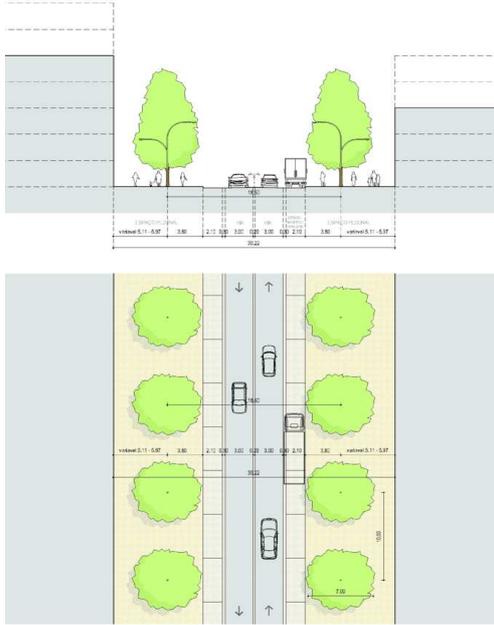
Modelo 1 (perfil tipo) | Projecto de Intervenção para a Avenida Dr. Lourenço Peixinho | Proposta preliminar p.32
